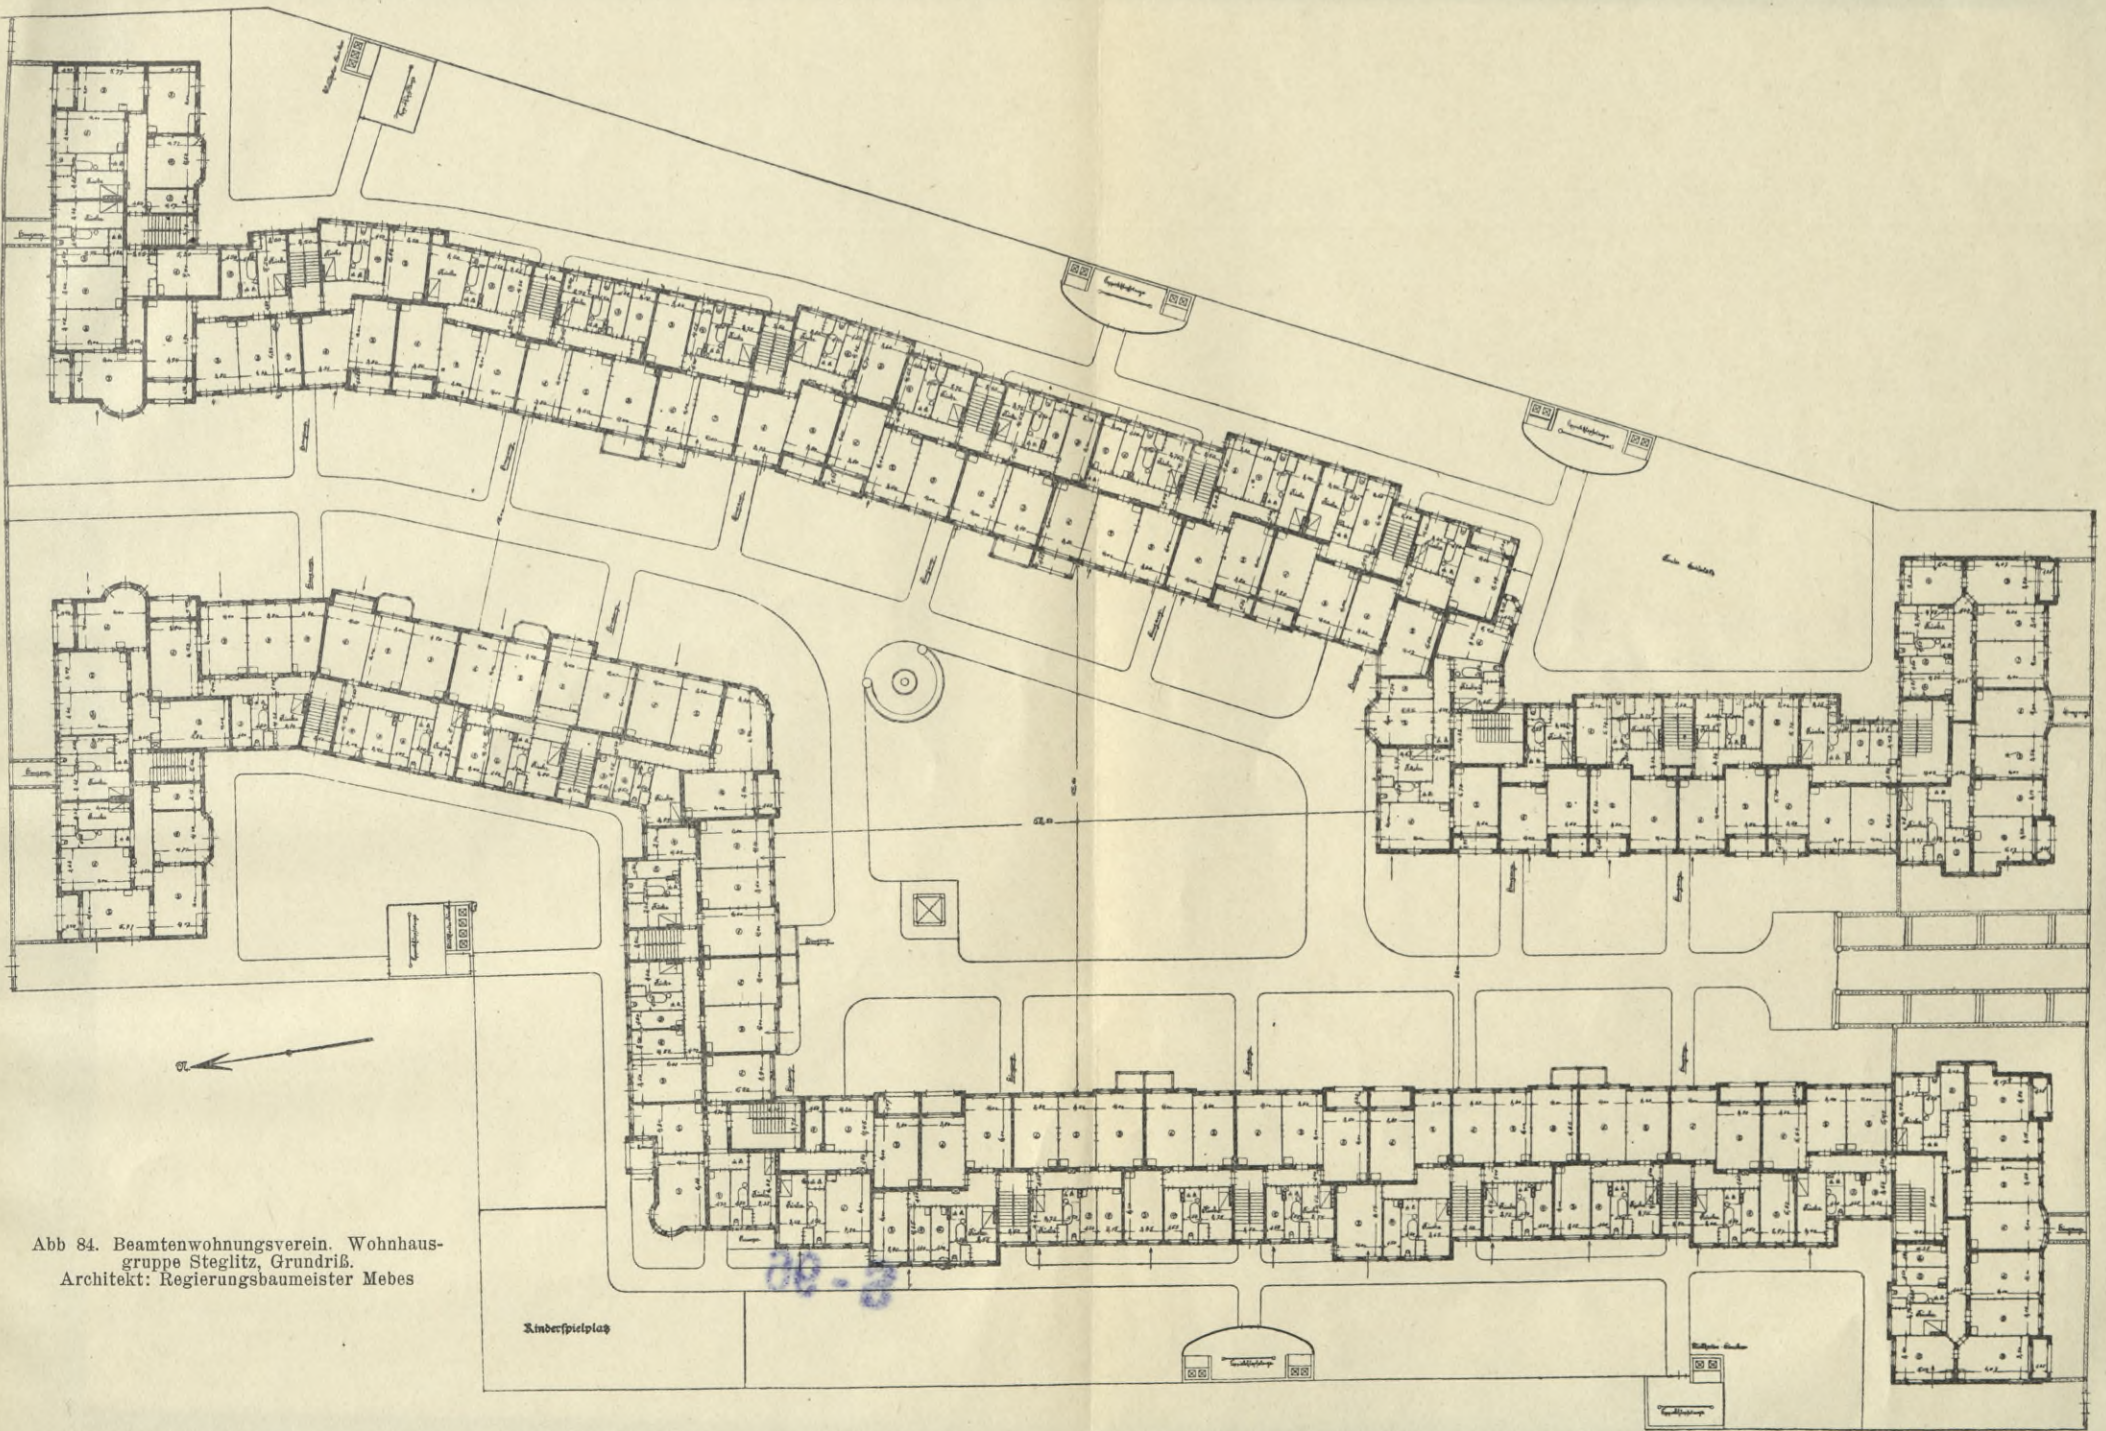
Beamtenwohnungsverein. Wohnhaus-
